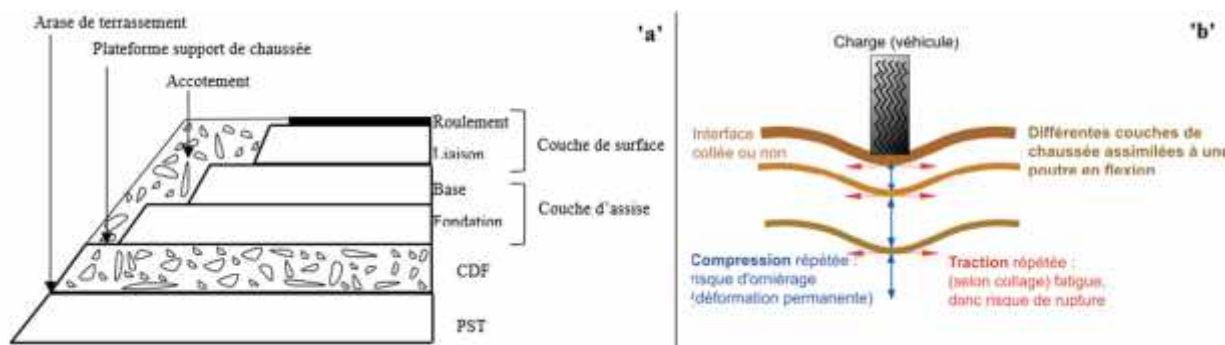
'a' Coupe type d'une structure de chaussée souple, 'b' Schéma de fonctionnement d'une structure de chaussée sous application d'une charge roulante (Mahoub M.et al., 2015).
